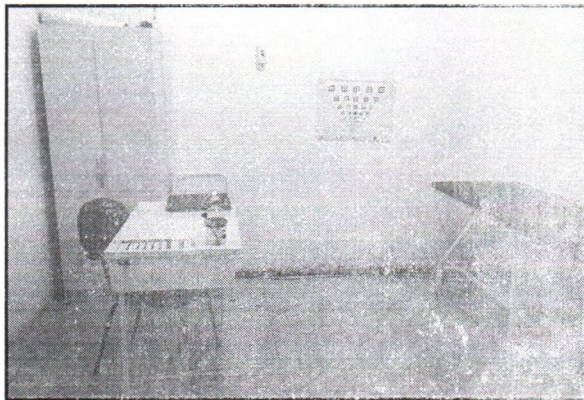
Vista de Sala de Enfermagem, com destaque a umidade em paredes
